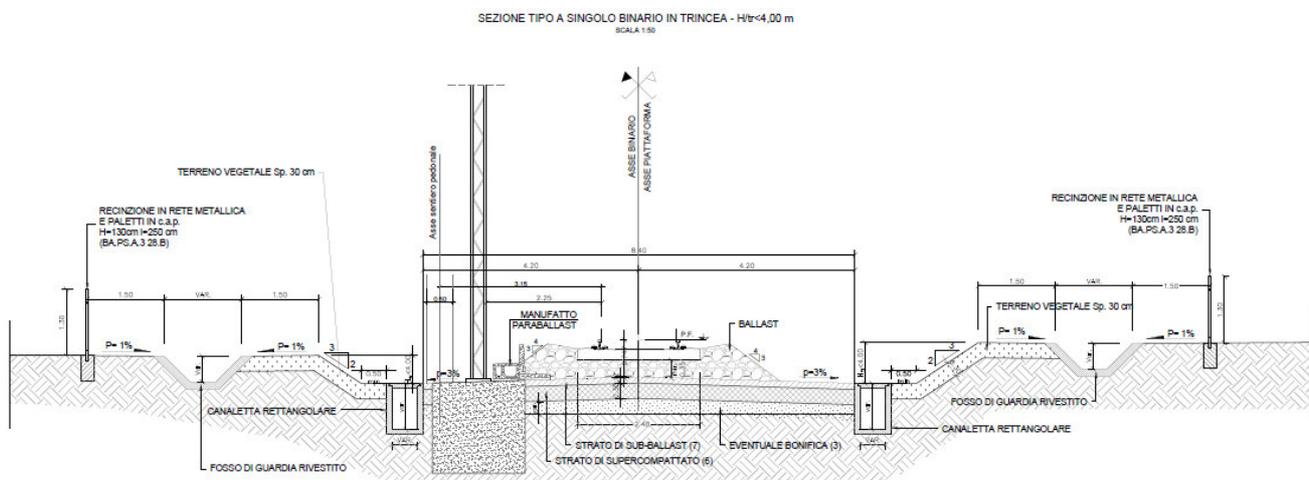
Corpo stradale ferroviario - Sezione tipo in trincea - altezze < di 4m
